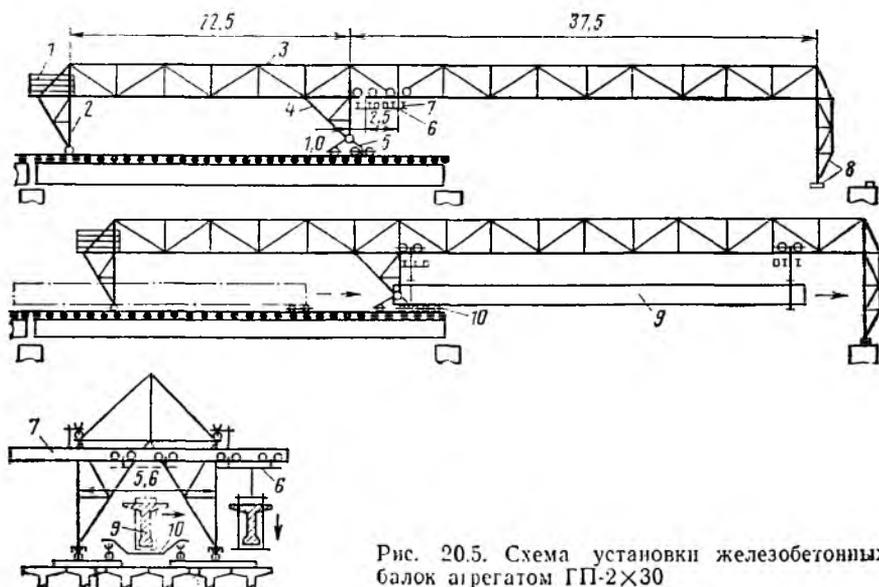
Схема установки железобетонных блоков агрегатом ГП-2×30
